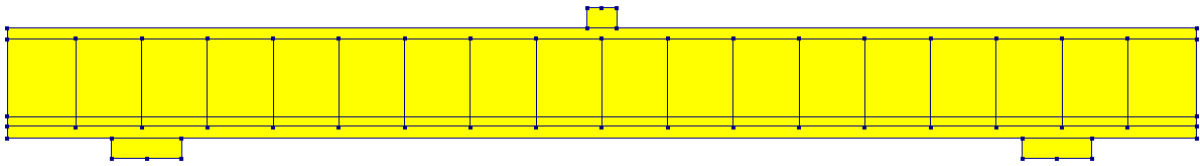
Vista del armado en una de las vigas estudiadas en el modelo.
